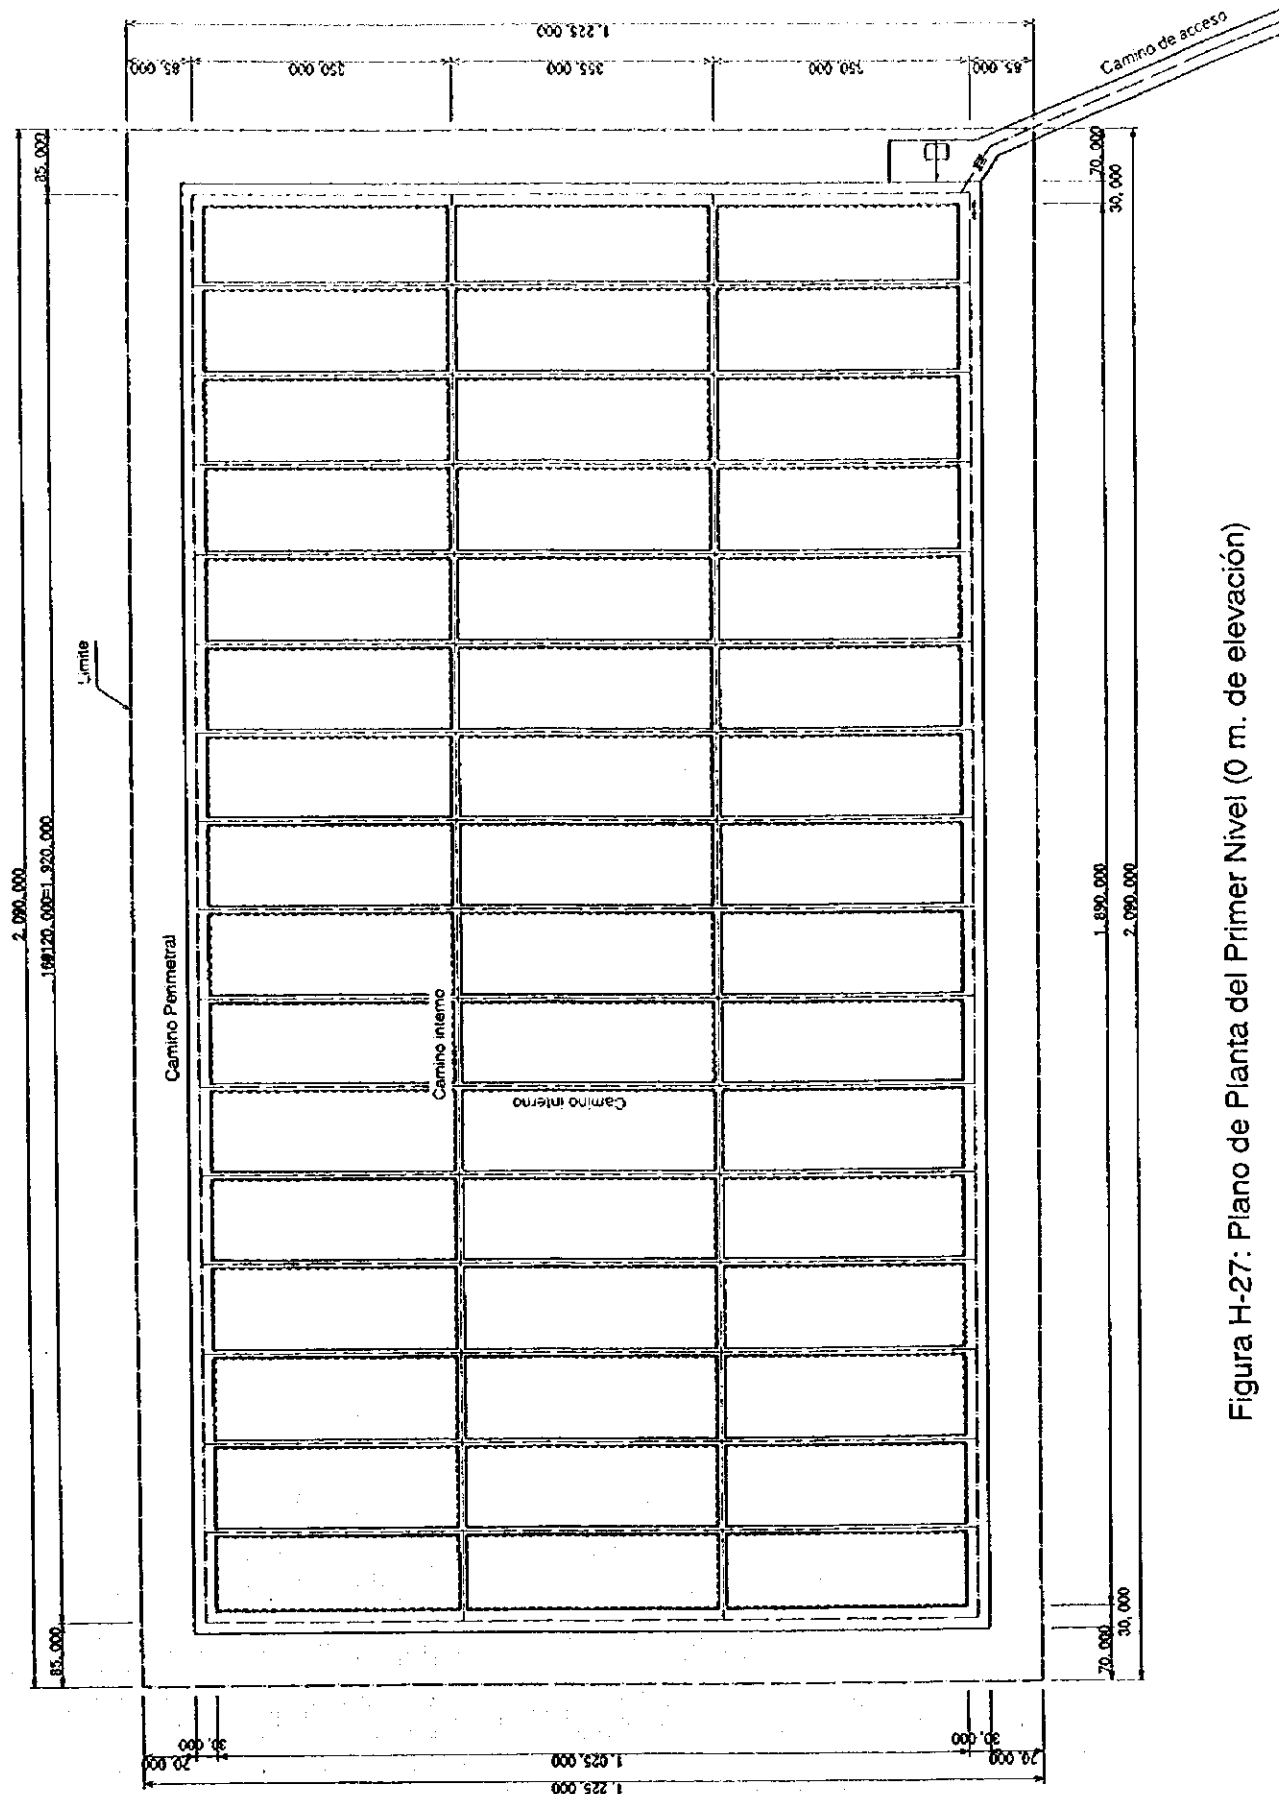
Plano de Planta del Primer Nivel (0 m. de elevación)
